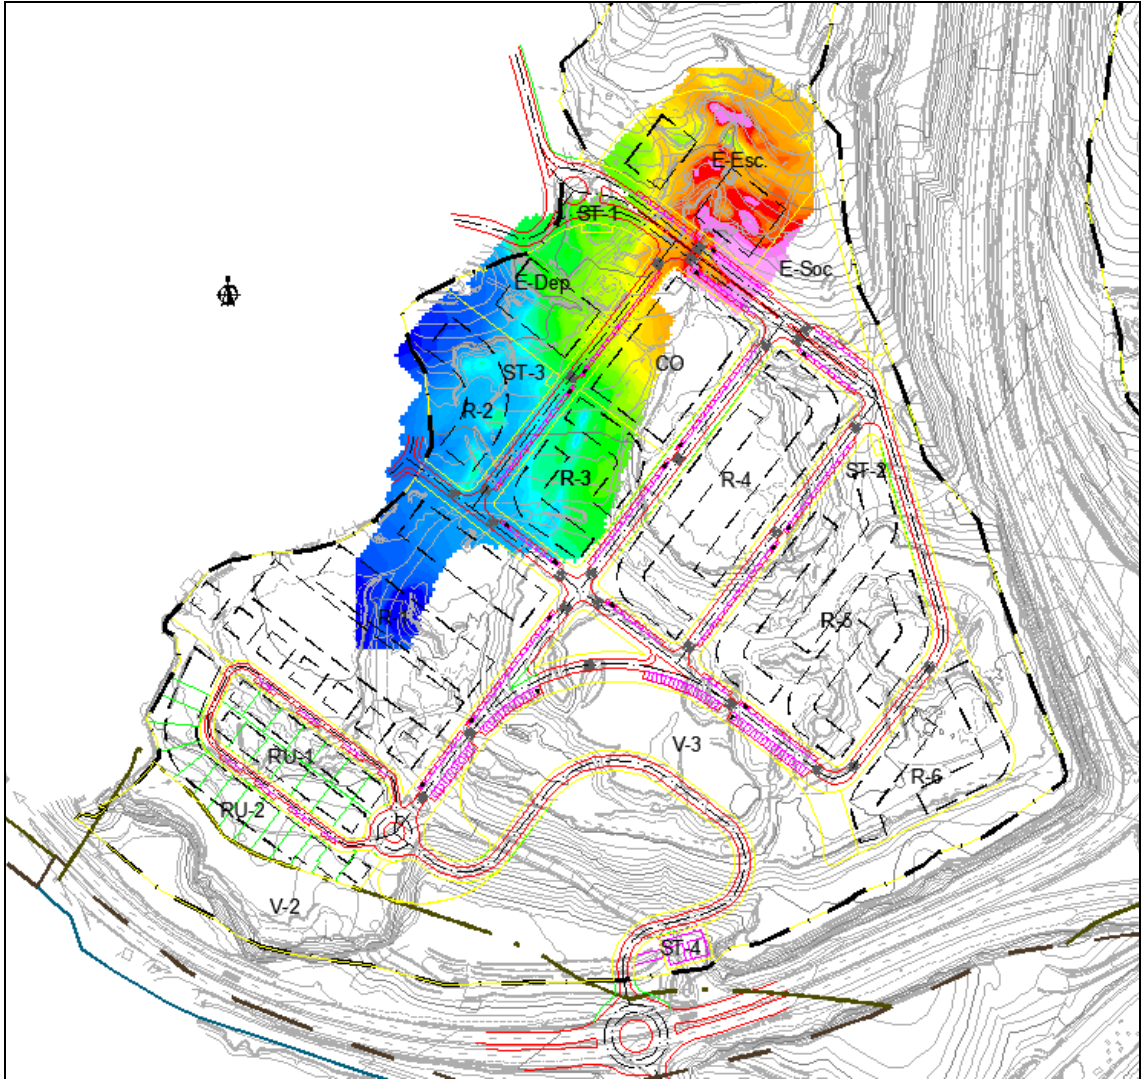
Plano de planta de ubicación de prospecciones (Microgravimetría).
